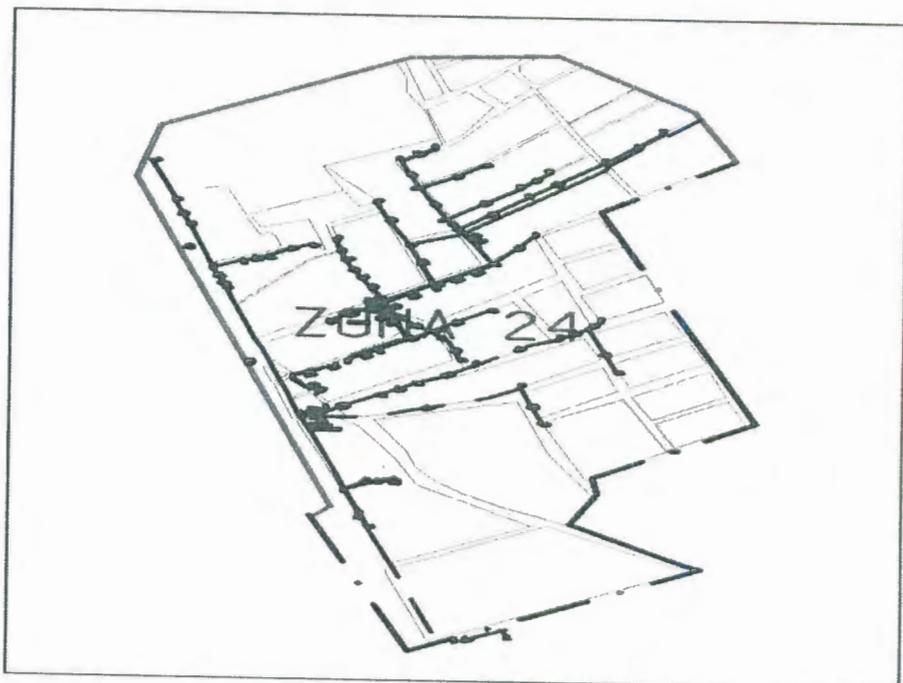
Planimetría zona 24 del sector de la vía a Daule
